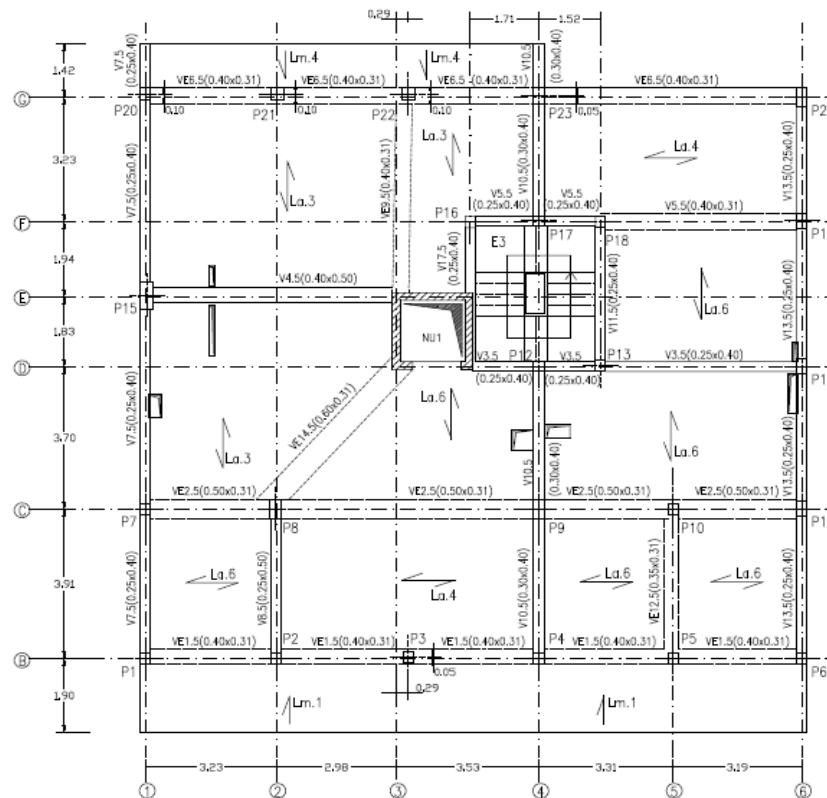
Planta estrutural do piso tipo do edifício de Guimarães.
